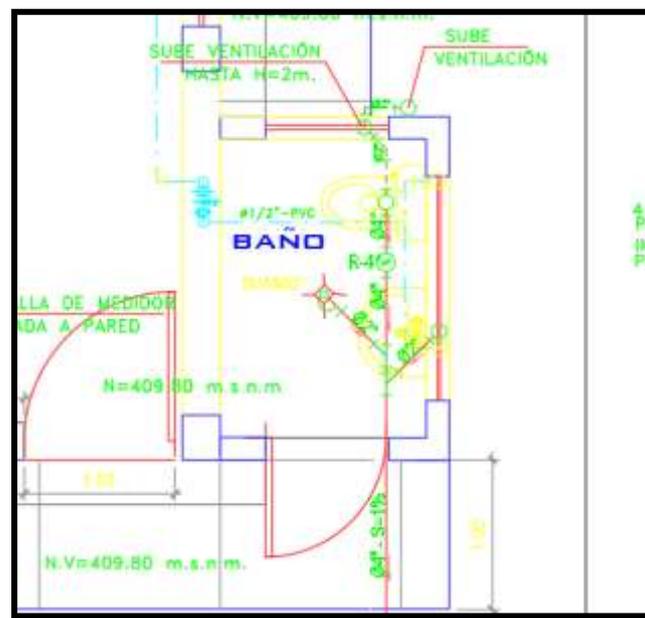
Plano en planta de una parte de la instalación de la vivienda multifamiliar “El Álamo”
